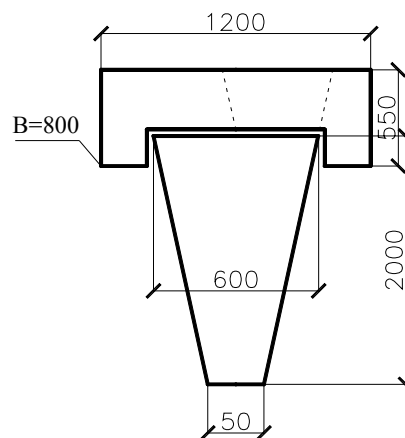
Пірамідальна палія зі збірним залізобетонним оголовником (Одеський ІБІ)
